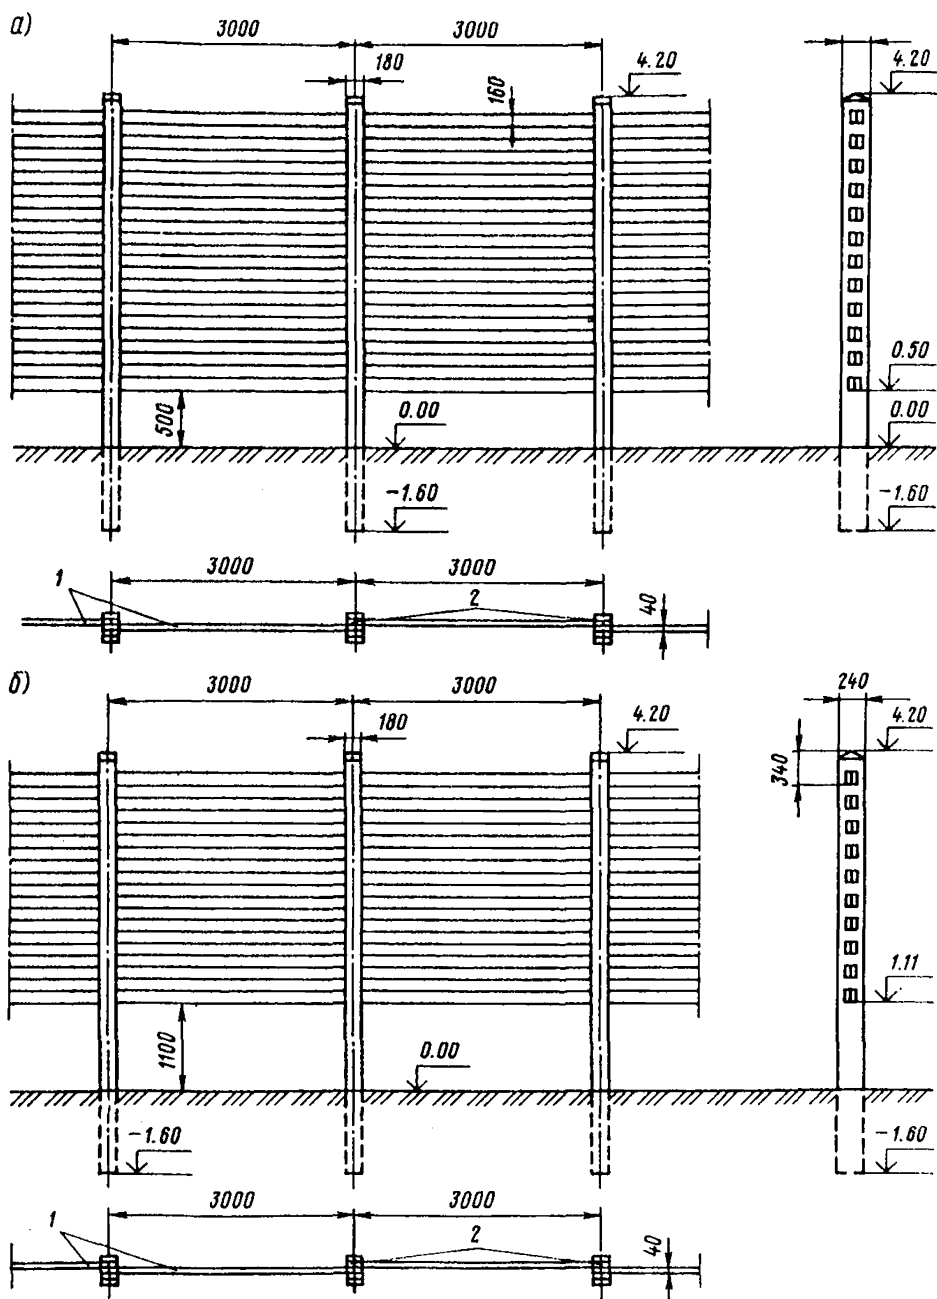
Схемы путевого (а) и полевого (б) железобетонных снегозадерживающих заборов сборной конструкции:
